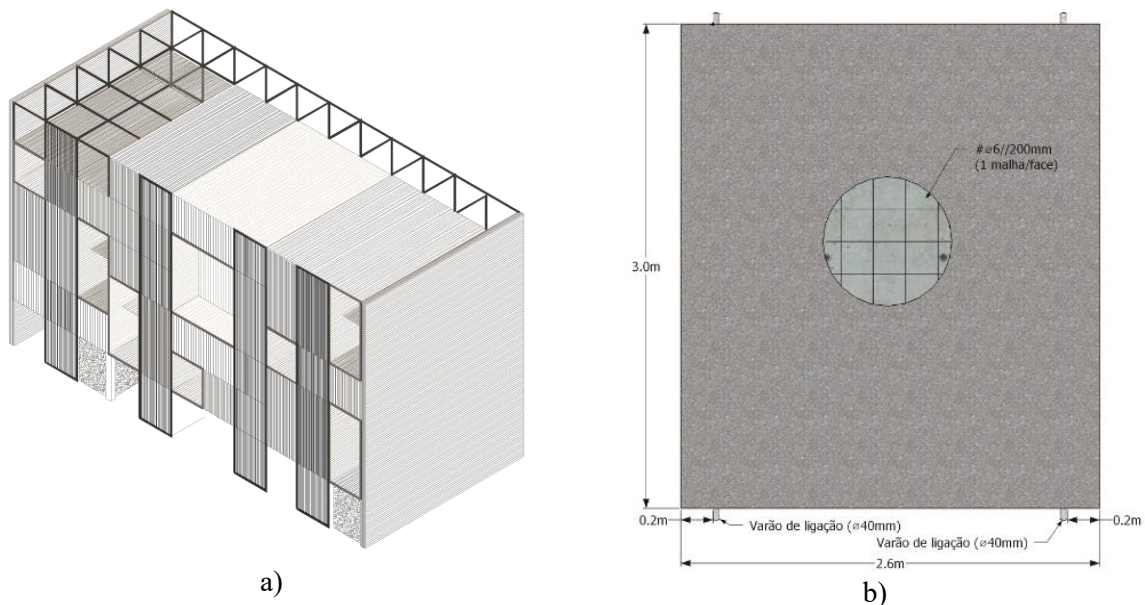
Sistema estrutural: a) vista 3D (elementos de barra ilustram a modularização); b) pormenor da parede estrutural tipo e disposição dos varões de ligação.
